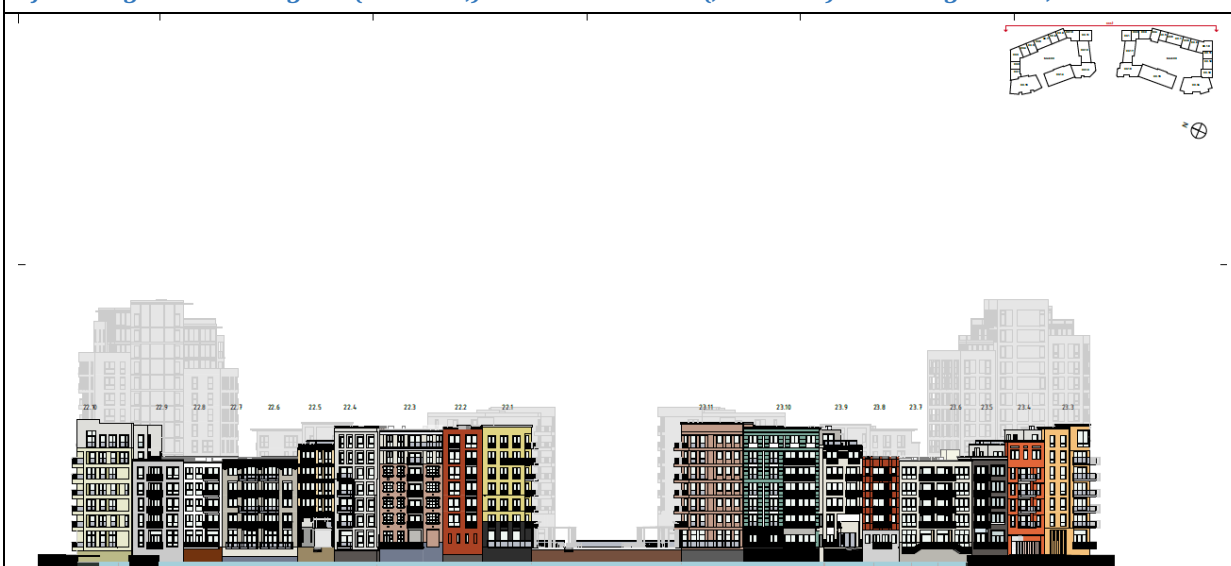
B: Noordgevel Blok 23 en Toren 23 – tekening nr. 121a, d.d. 23-3-2017
